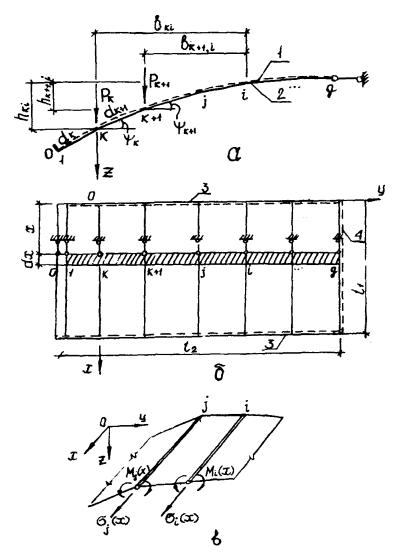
К построению расчетной схемы пластиныоболочки вариационным смещанным метолом а-поперечное сечение и нагрузки; 6-план и элементарная поперечная полоска; 6-схема неизвестных усилий; 1-заданное сечение; 2 -расчетное 3-шариирное опирание на панель КСО; 4-шариирное сопряжение со смежной пластиной
